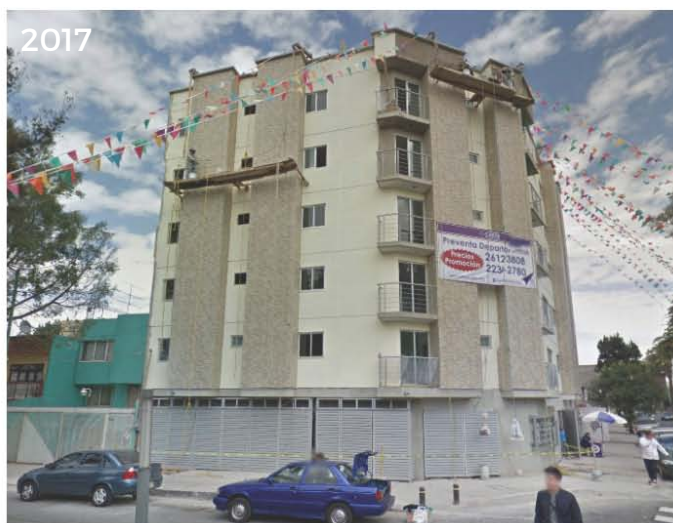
Construcciones nuevas sobre Genaro García
